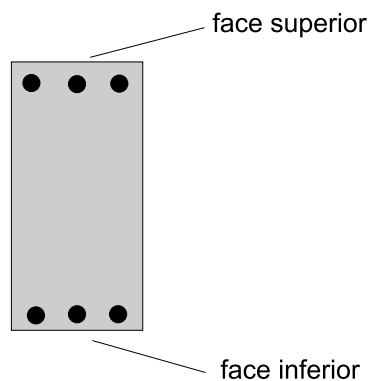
Distribuição das armaduras na seção transversal da viga.
